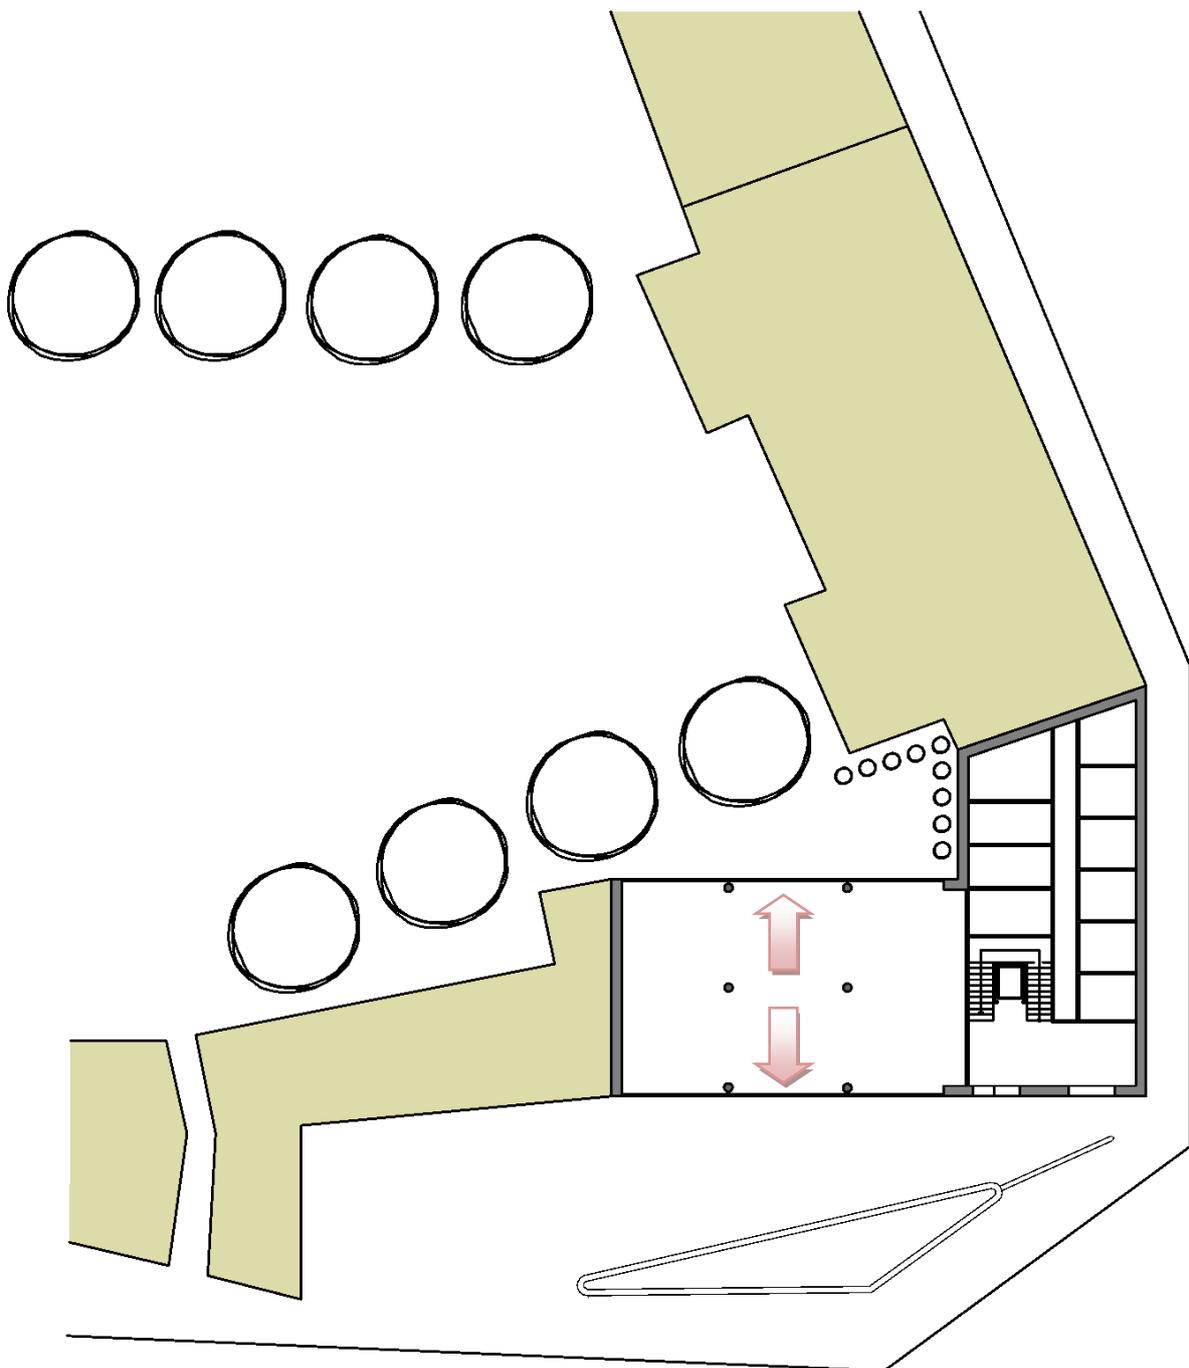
Grundriss (Bezug zur Umgebung)
